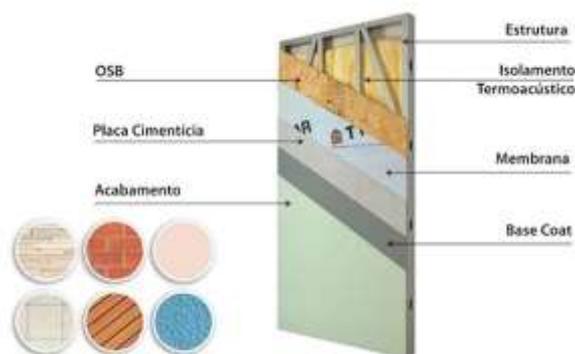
Sistema *Steel Frame* - estrutura em aço galvanizado:
